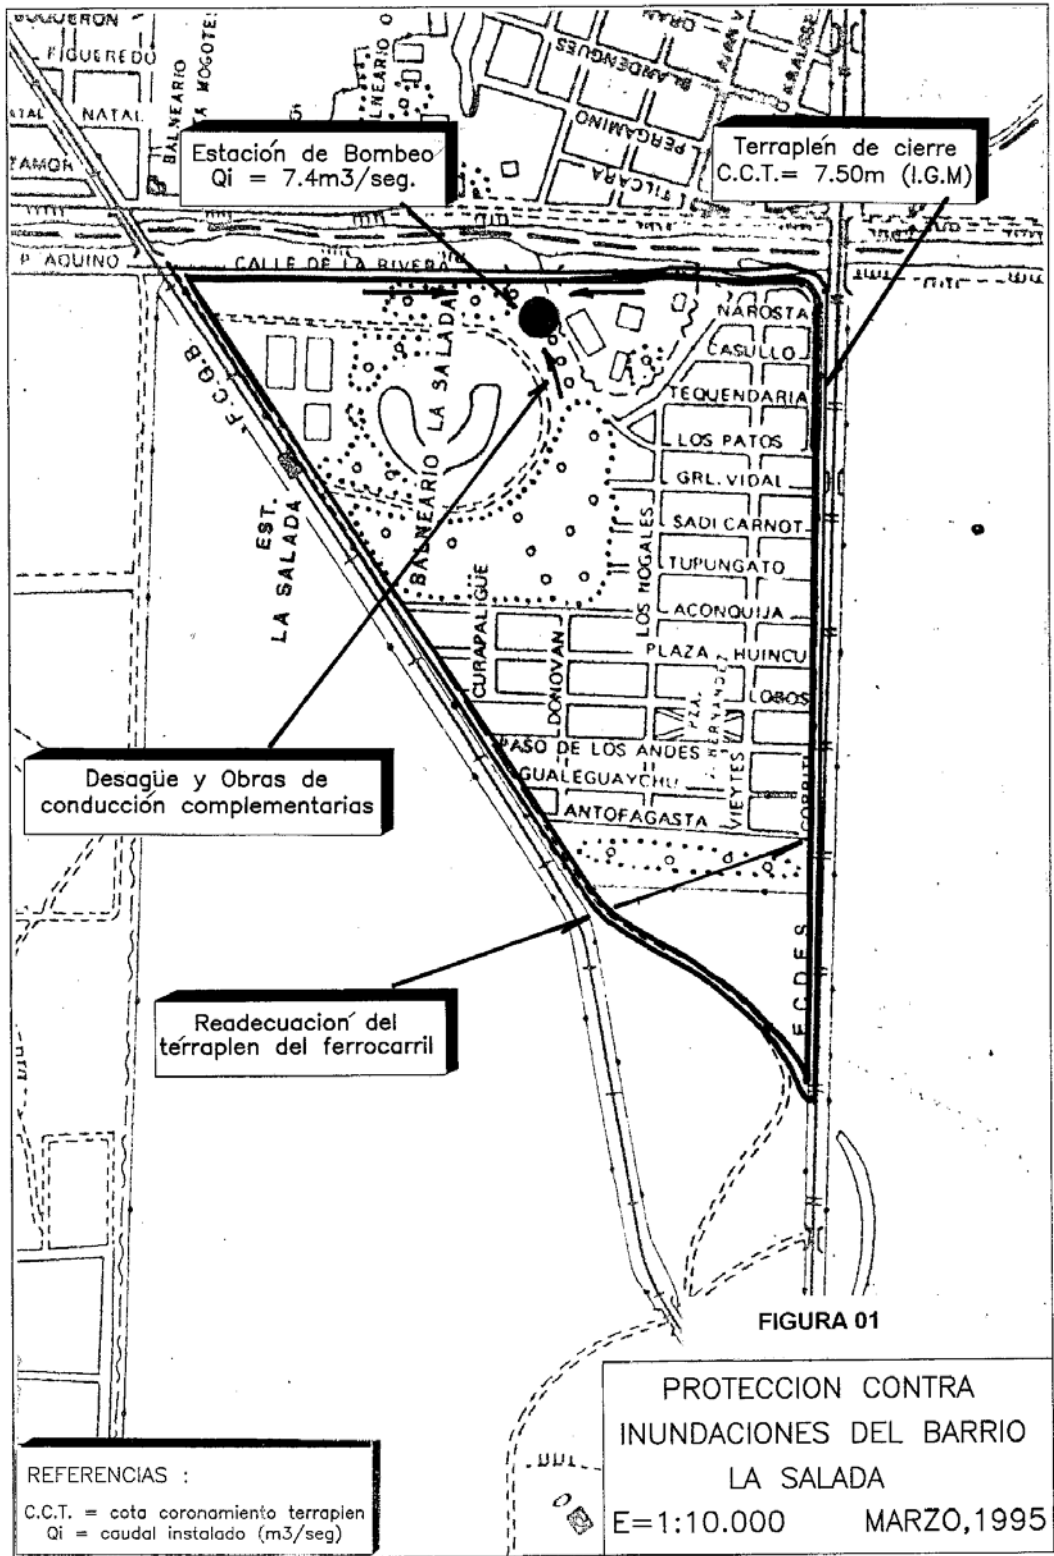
Protección contra inundaciones del Barrio La Salada previsto según el Plan de 1994
